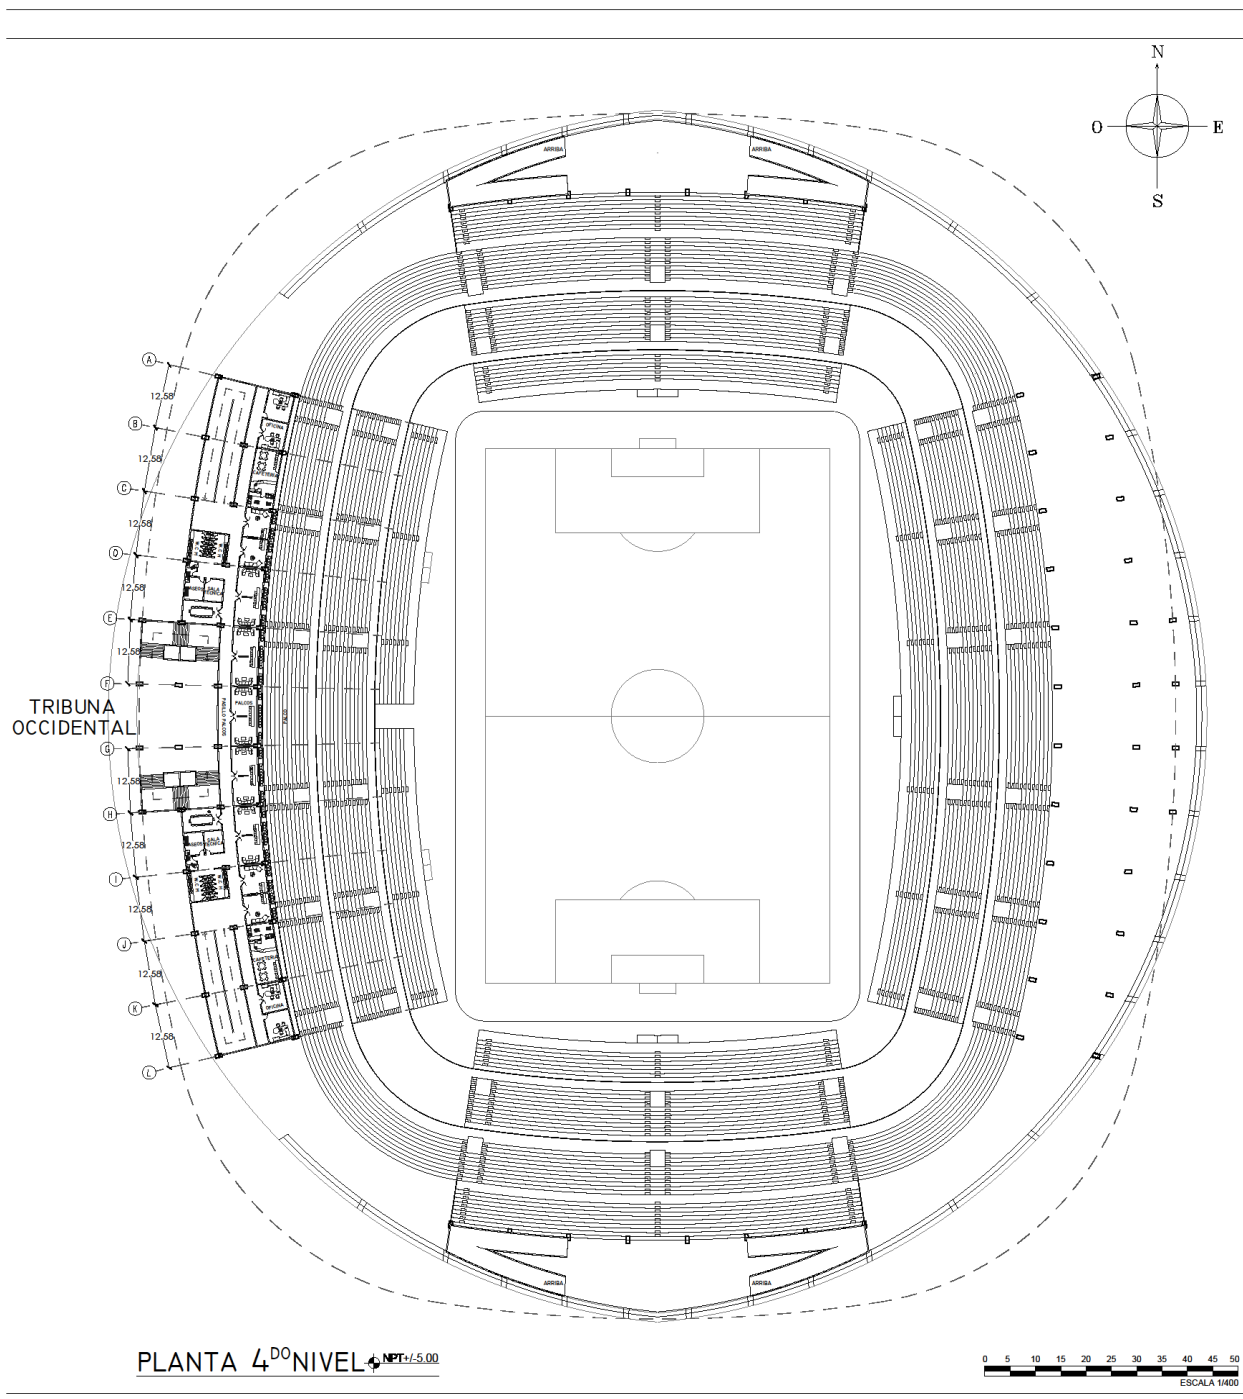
Planta 4 / Fuente Elaboración Propia
